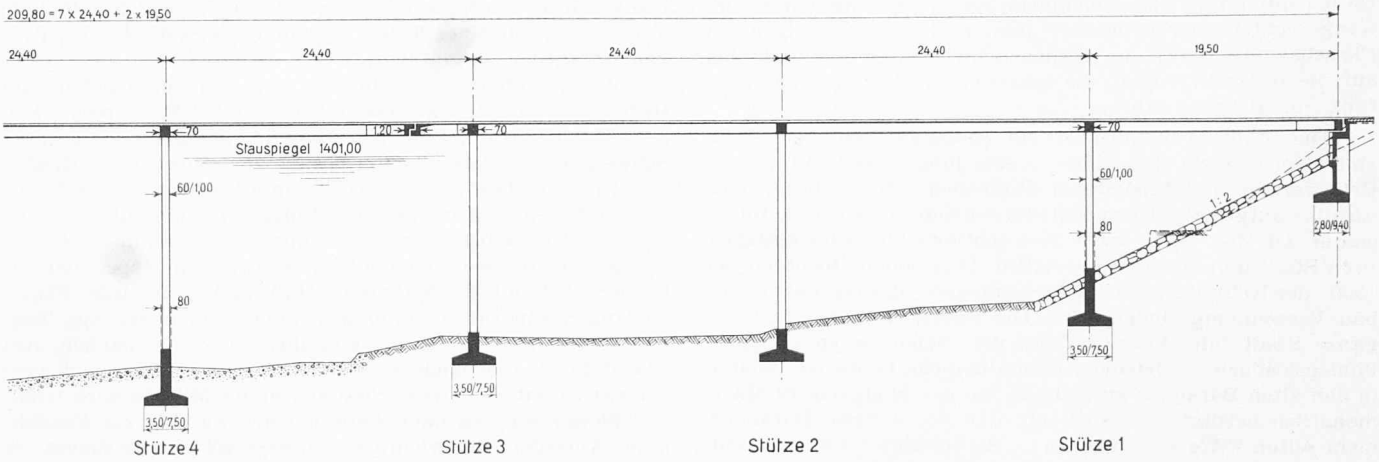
Steilerbachbrücke bei Sufers, Längsschnitt 1:600 (rechte Hälfte)
